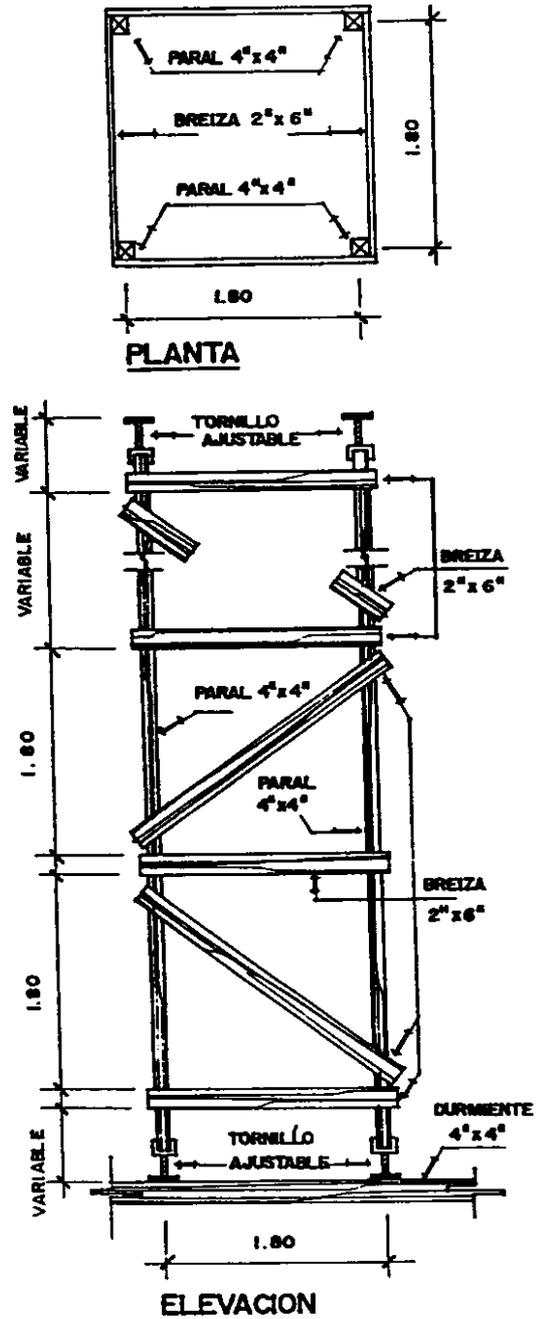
Fuente: Peurifoy, R.L. Encofrados para estructuras de hormigón. p. 105
